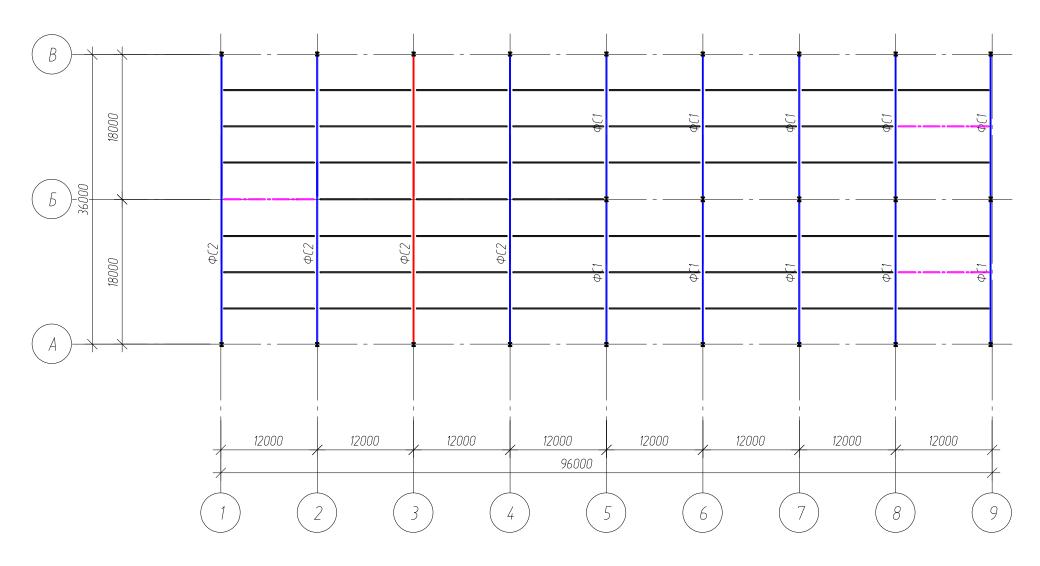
«Схема расположения связей и распорок по нижним поясам ферм» [14]
